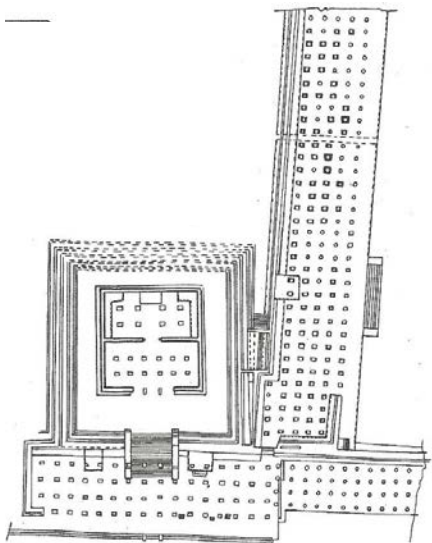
Plano de la Estructura de Los Guerreros, la cual cubrió a la Subestructura, junto con la Columnata del Noroeste y las Mil Columnas
